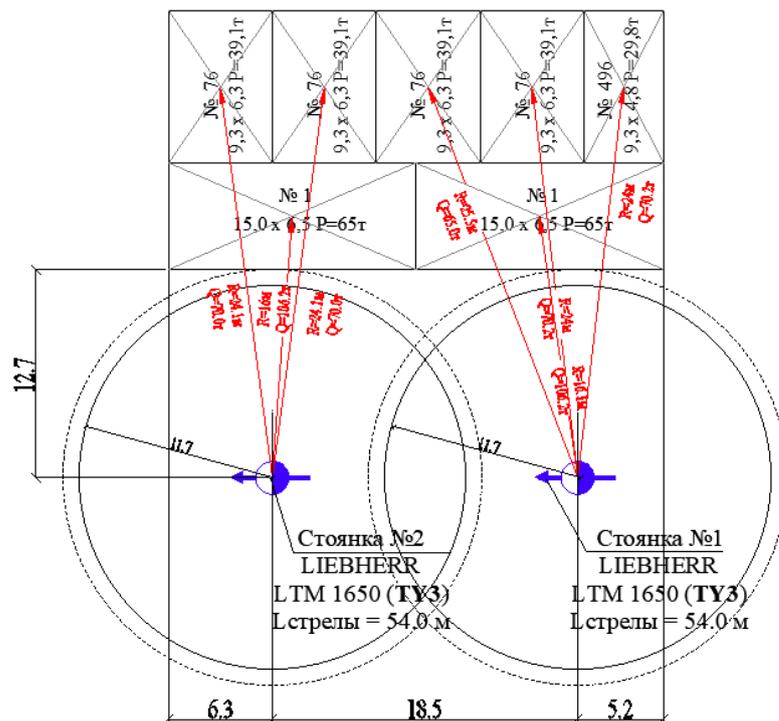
Схема имитационного моделирования механизации монтажных работ мобильным краном на спецшасси для односекционного прямоугольного жилого здания «Тип 2а». План
